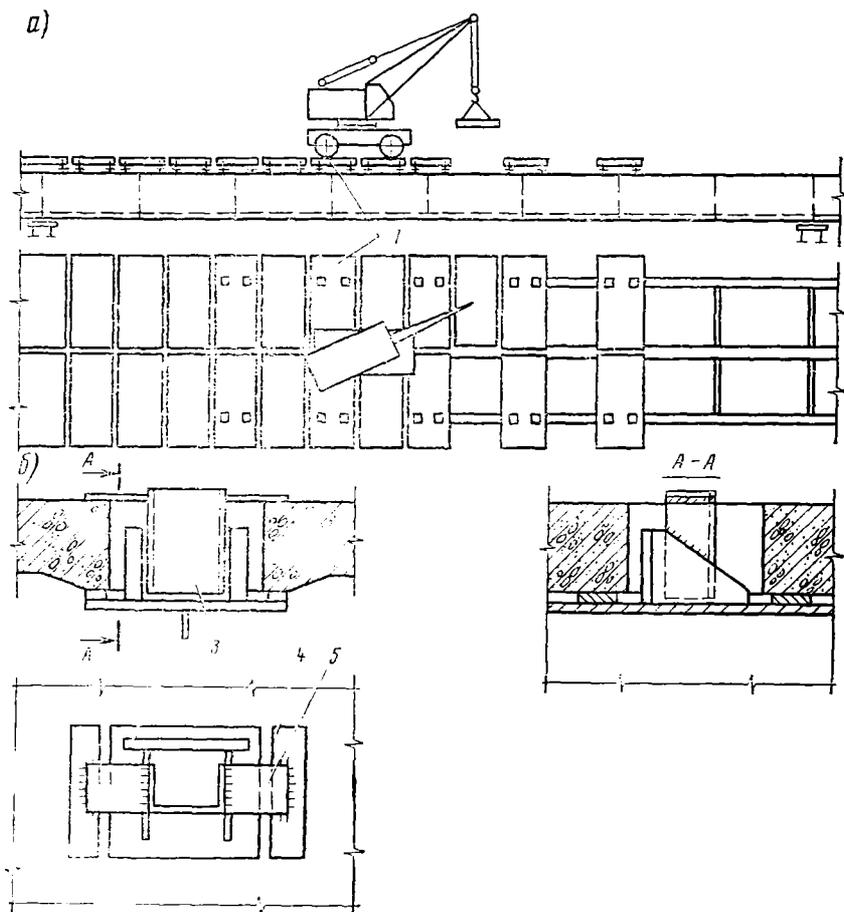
Схема временных верхних связей из блоков железобетонной плиты и конструкция монтажного соединения
